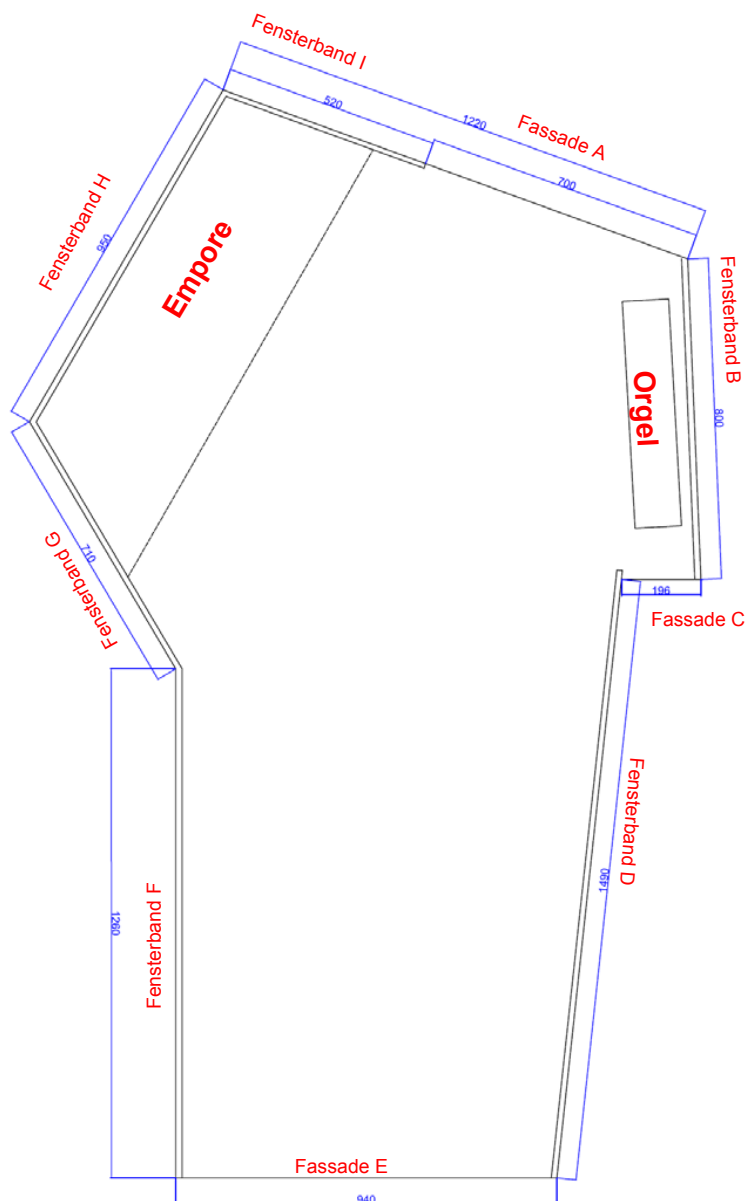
Grundriss und Nummerierungsplan des Kirchraums
